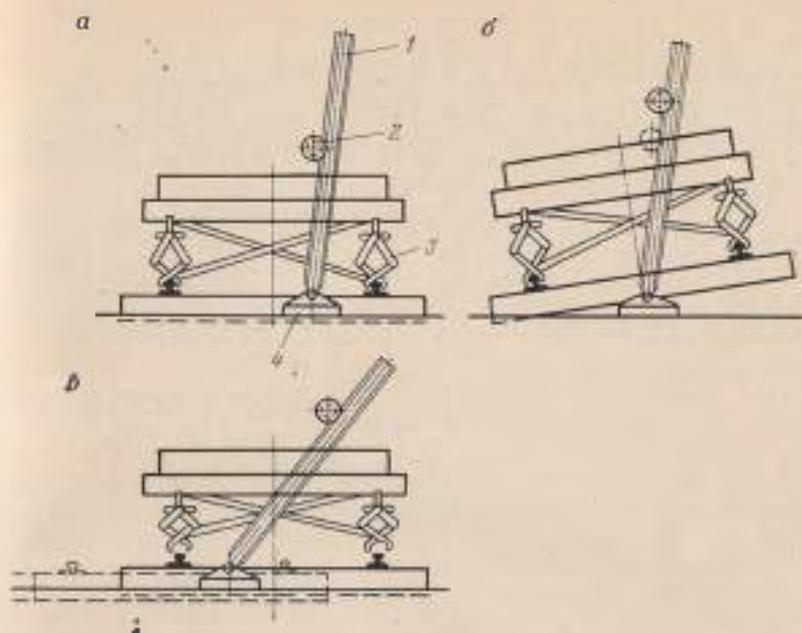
Схема работы путепередвигателя непрерывного действия: а — исходное положение; б — левый путь; в — конечное положение; 1 — зубчатая рейка, 2 — паровая шестерня; 3 — захват; 4 — ролик
